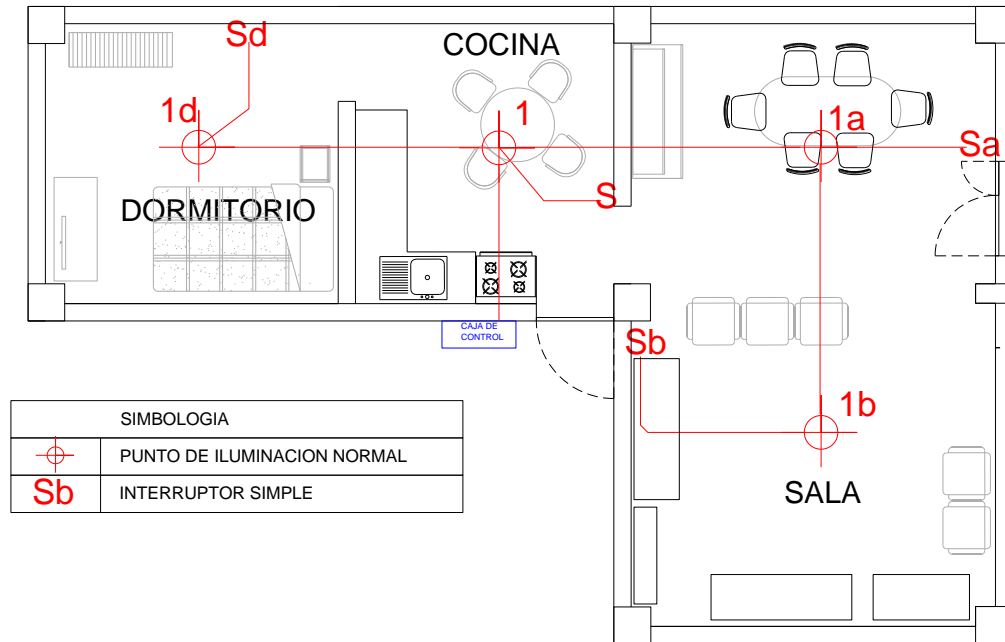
Plano eléctrico y control. Fuente: Elaborado por el autor
